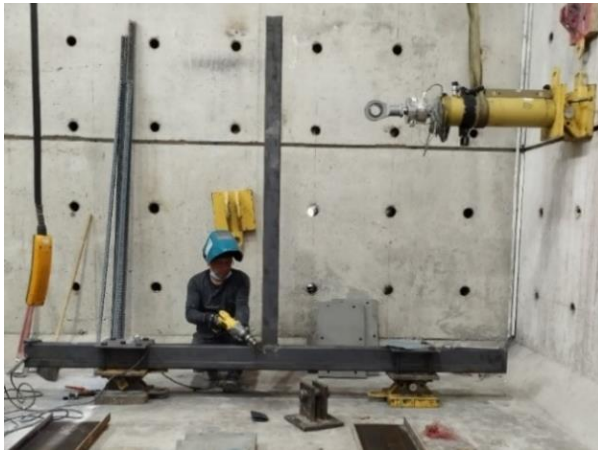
Fijación y conexión de viga - columna 100x100x2 mm, mediante cordón de suelda.
